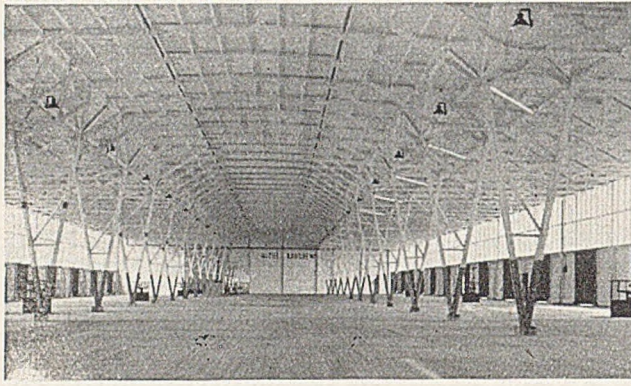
Schuppen 58, Holzfachwerkbinder mit flach gegründeten Mittelstützen (Außenstützen auf Pfählen).
